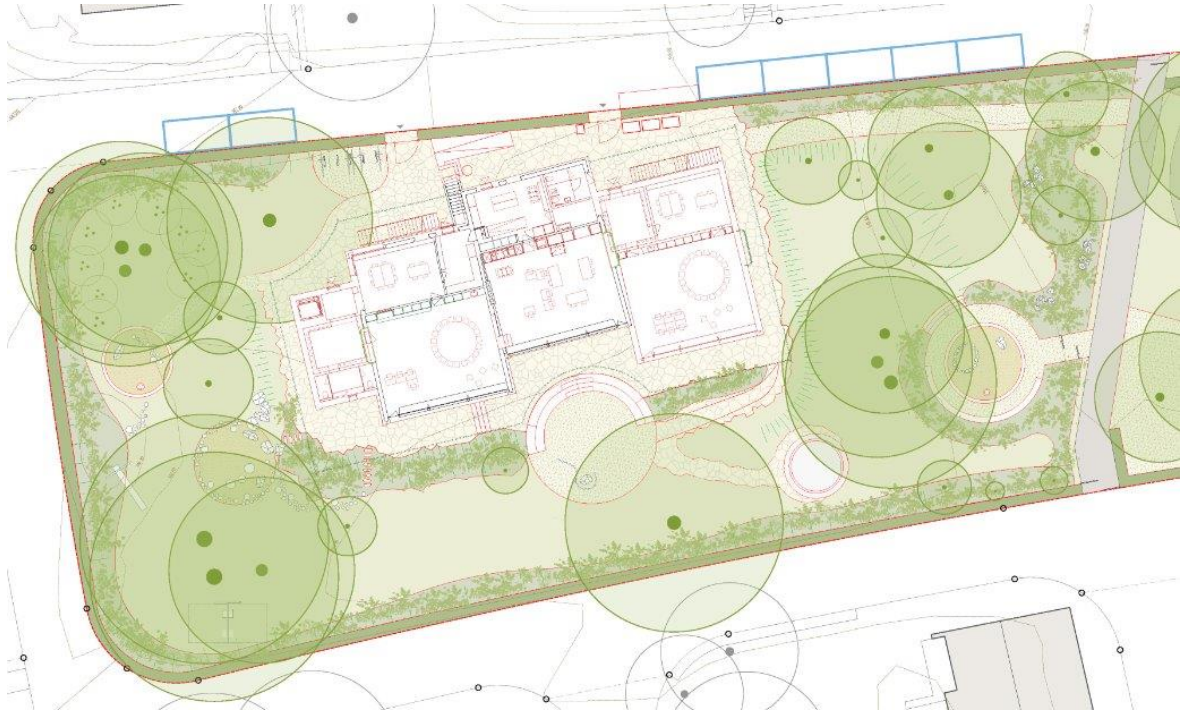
Plan Erdgeschoss mit Aussenraum
